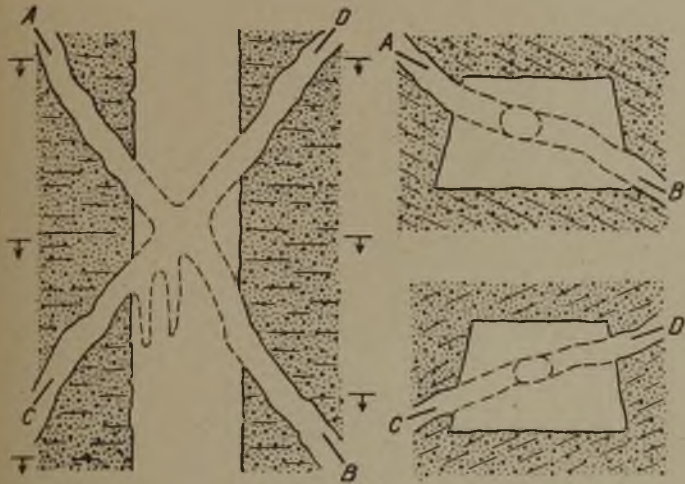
Grundriß. Abb. 15. Längsschnitte.
